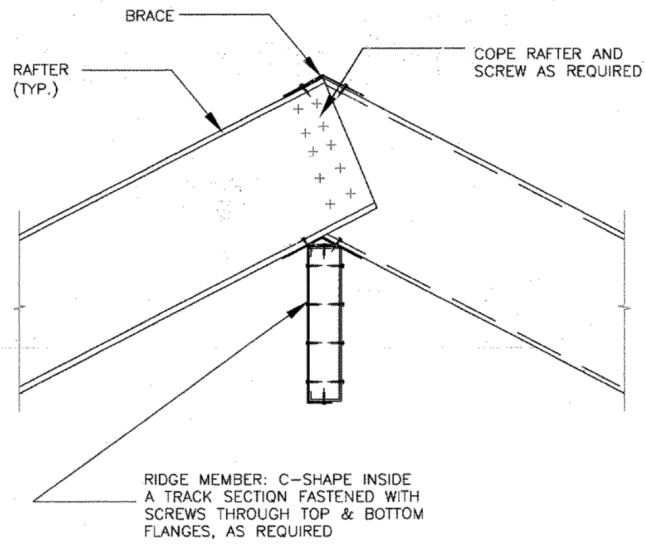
Conexión y apoyo a los cabezales articulados del techo
